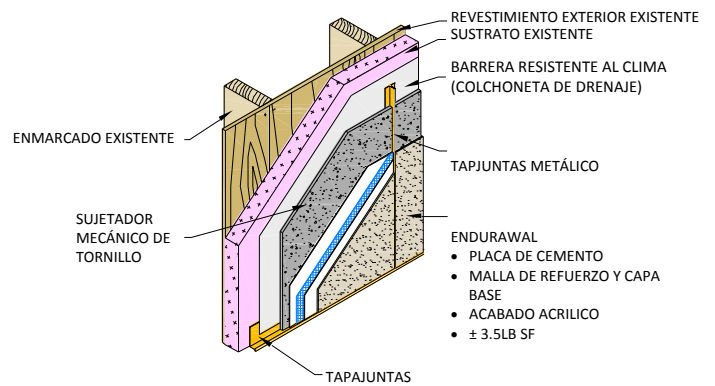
Pared Estándar con Aislamiento Rígido
